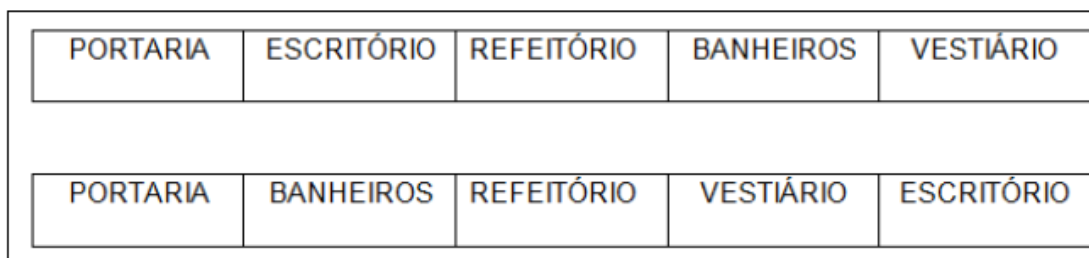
Dois tipos de disposição para layout do canteiro de obras.
